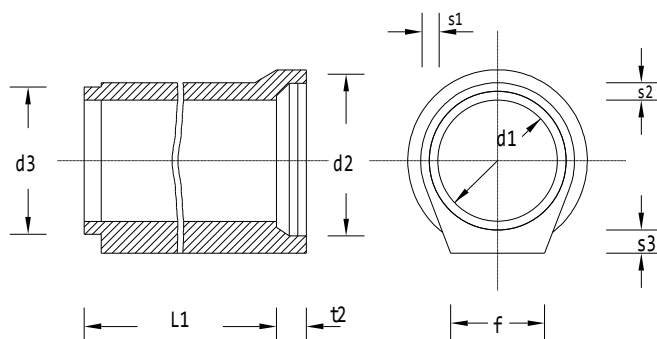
tubi in calcestruzzo di sezione circolare con manicotto e con piede di appoggio
